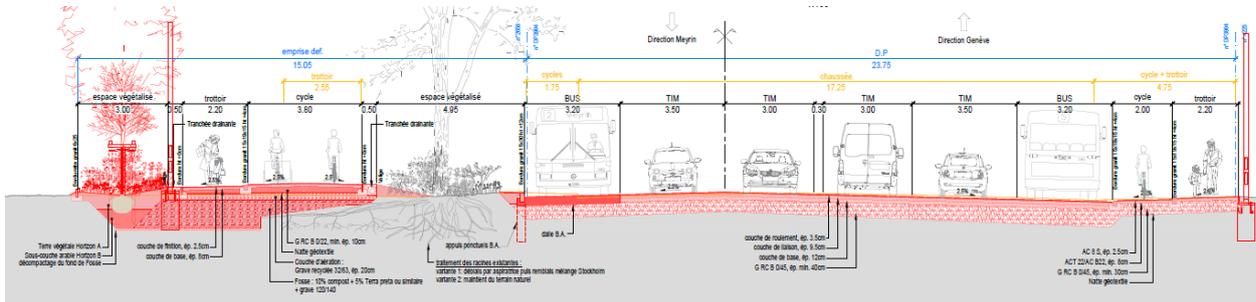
Coupe sur la route de Vernier cantonale au droit de VERTISSA
